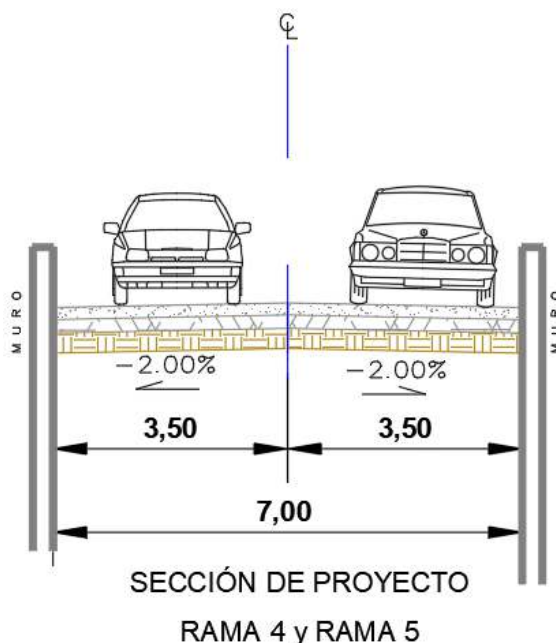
Sección tipo propuesta de la zona de estudio. Fuente: (Propia)
